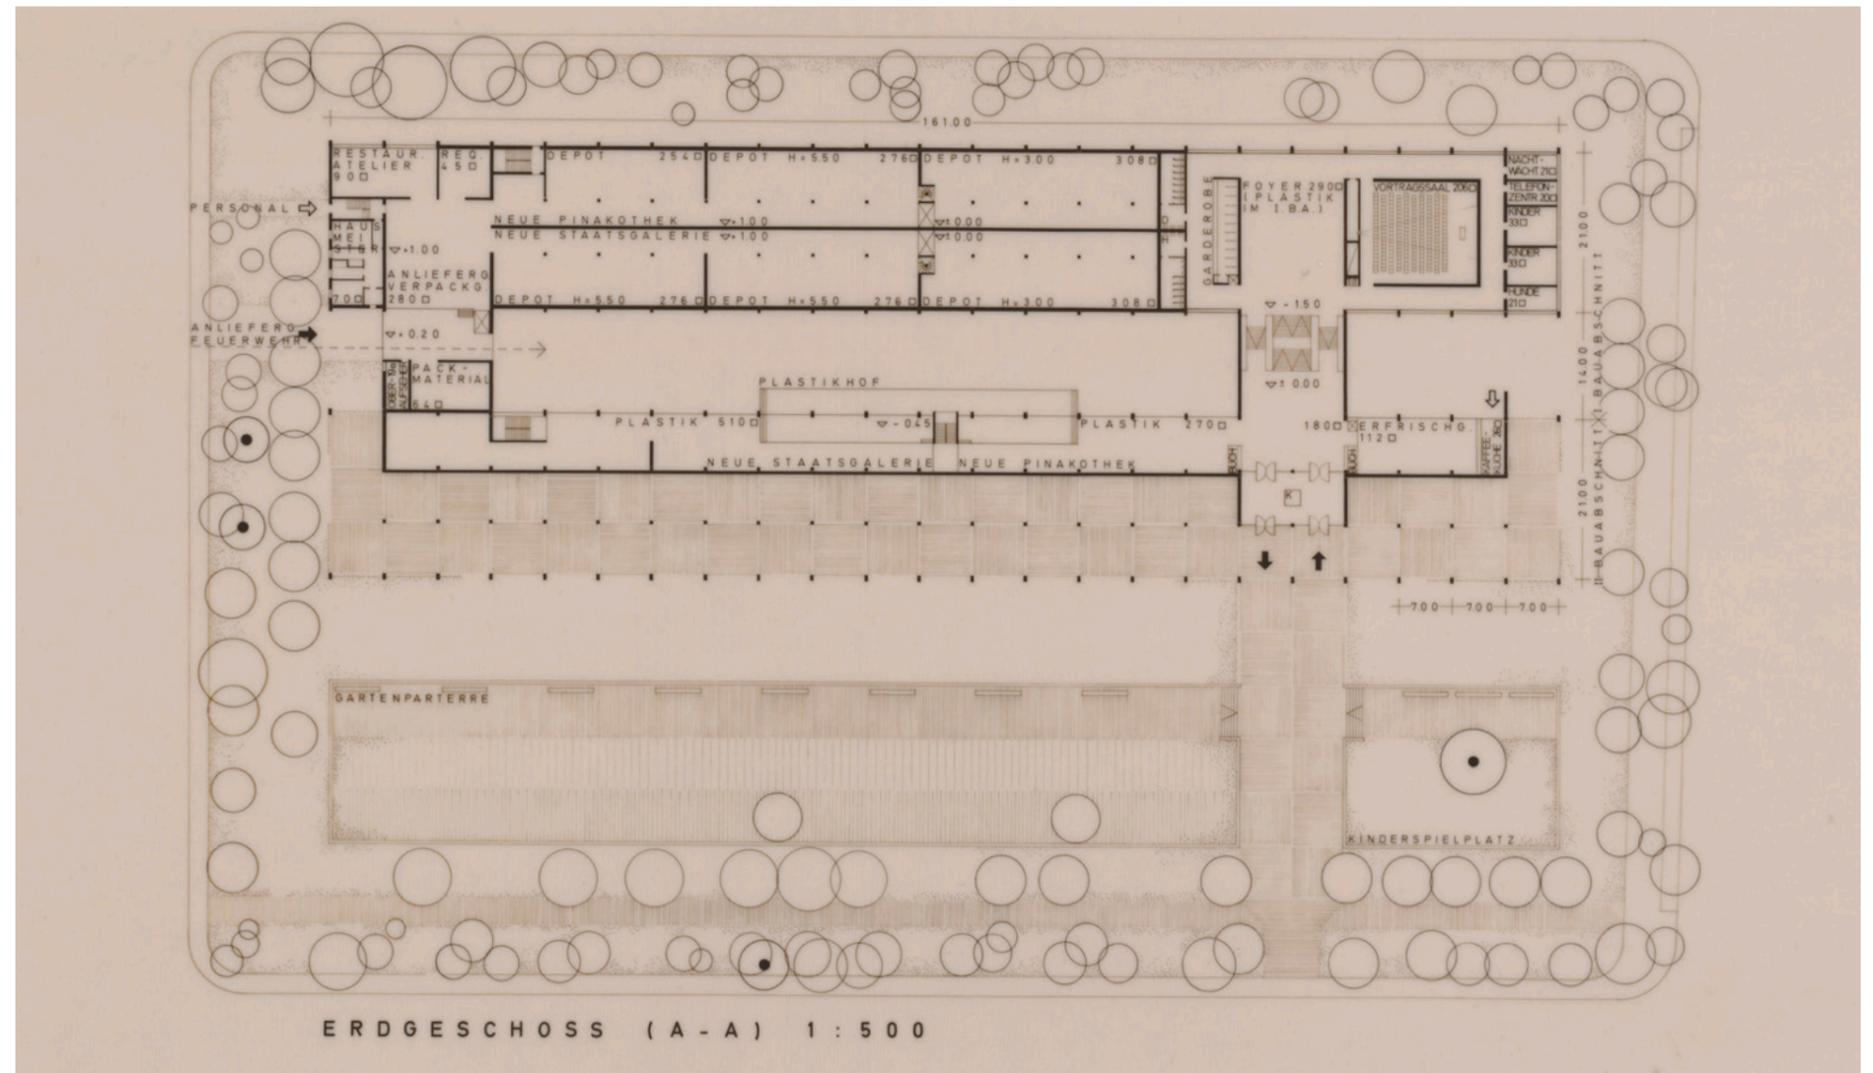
Grundriss EG (A-A) und Umgebung, Planzeichnung
